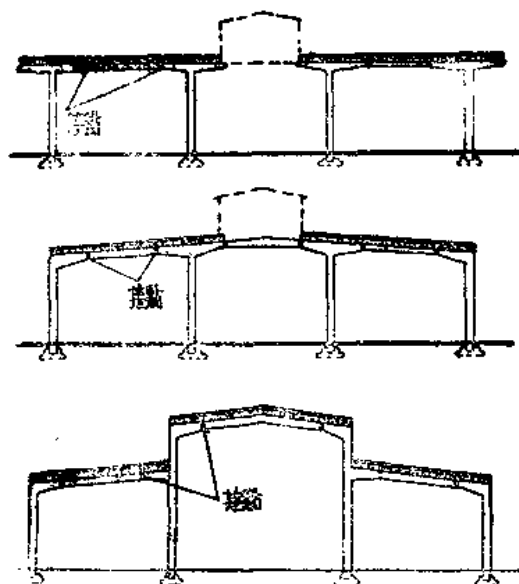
單層工業廠房中予制鋼筋混凝土框架的形式
